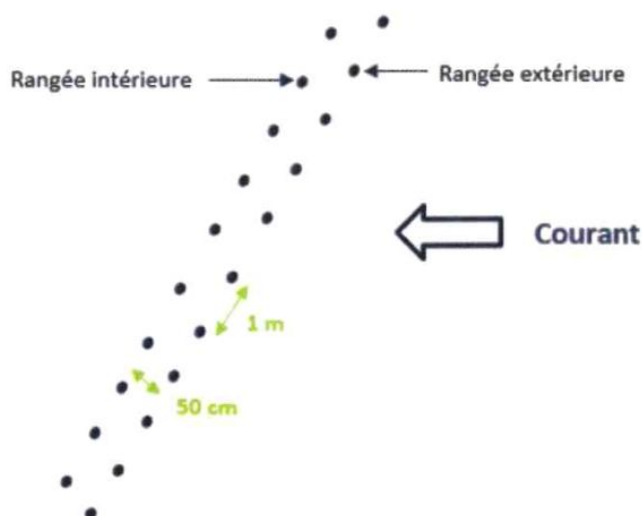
Plan de principe détaillé du dispositif d'accrétion (variante 1)
